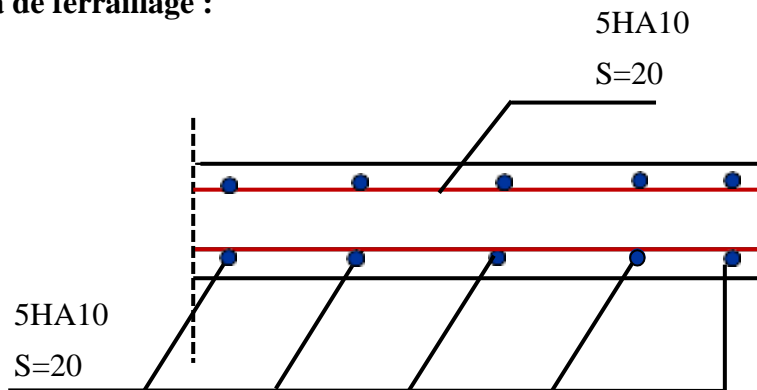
Schéma de ferrailage de la dalle sur 2 appuis
